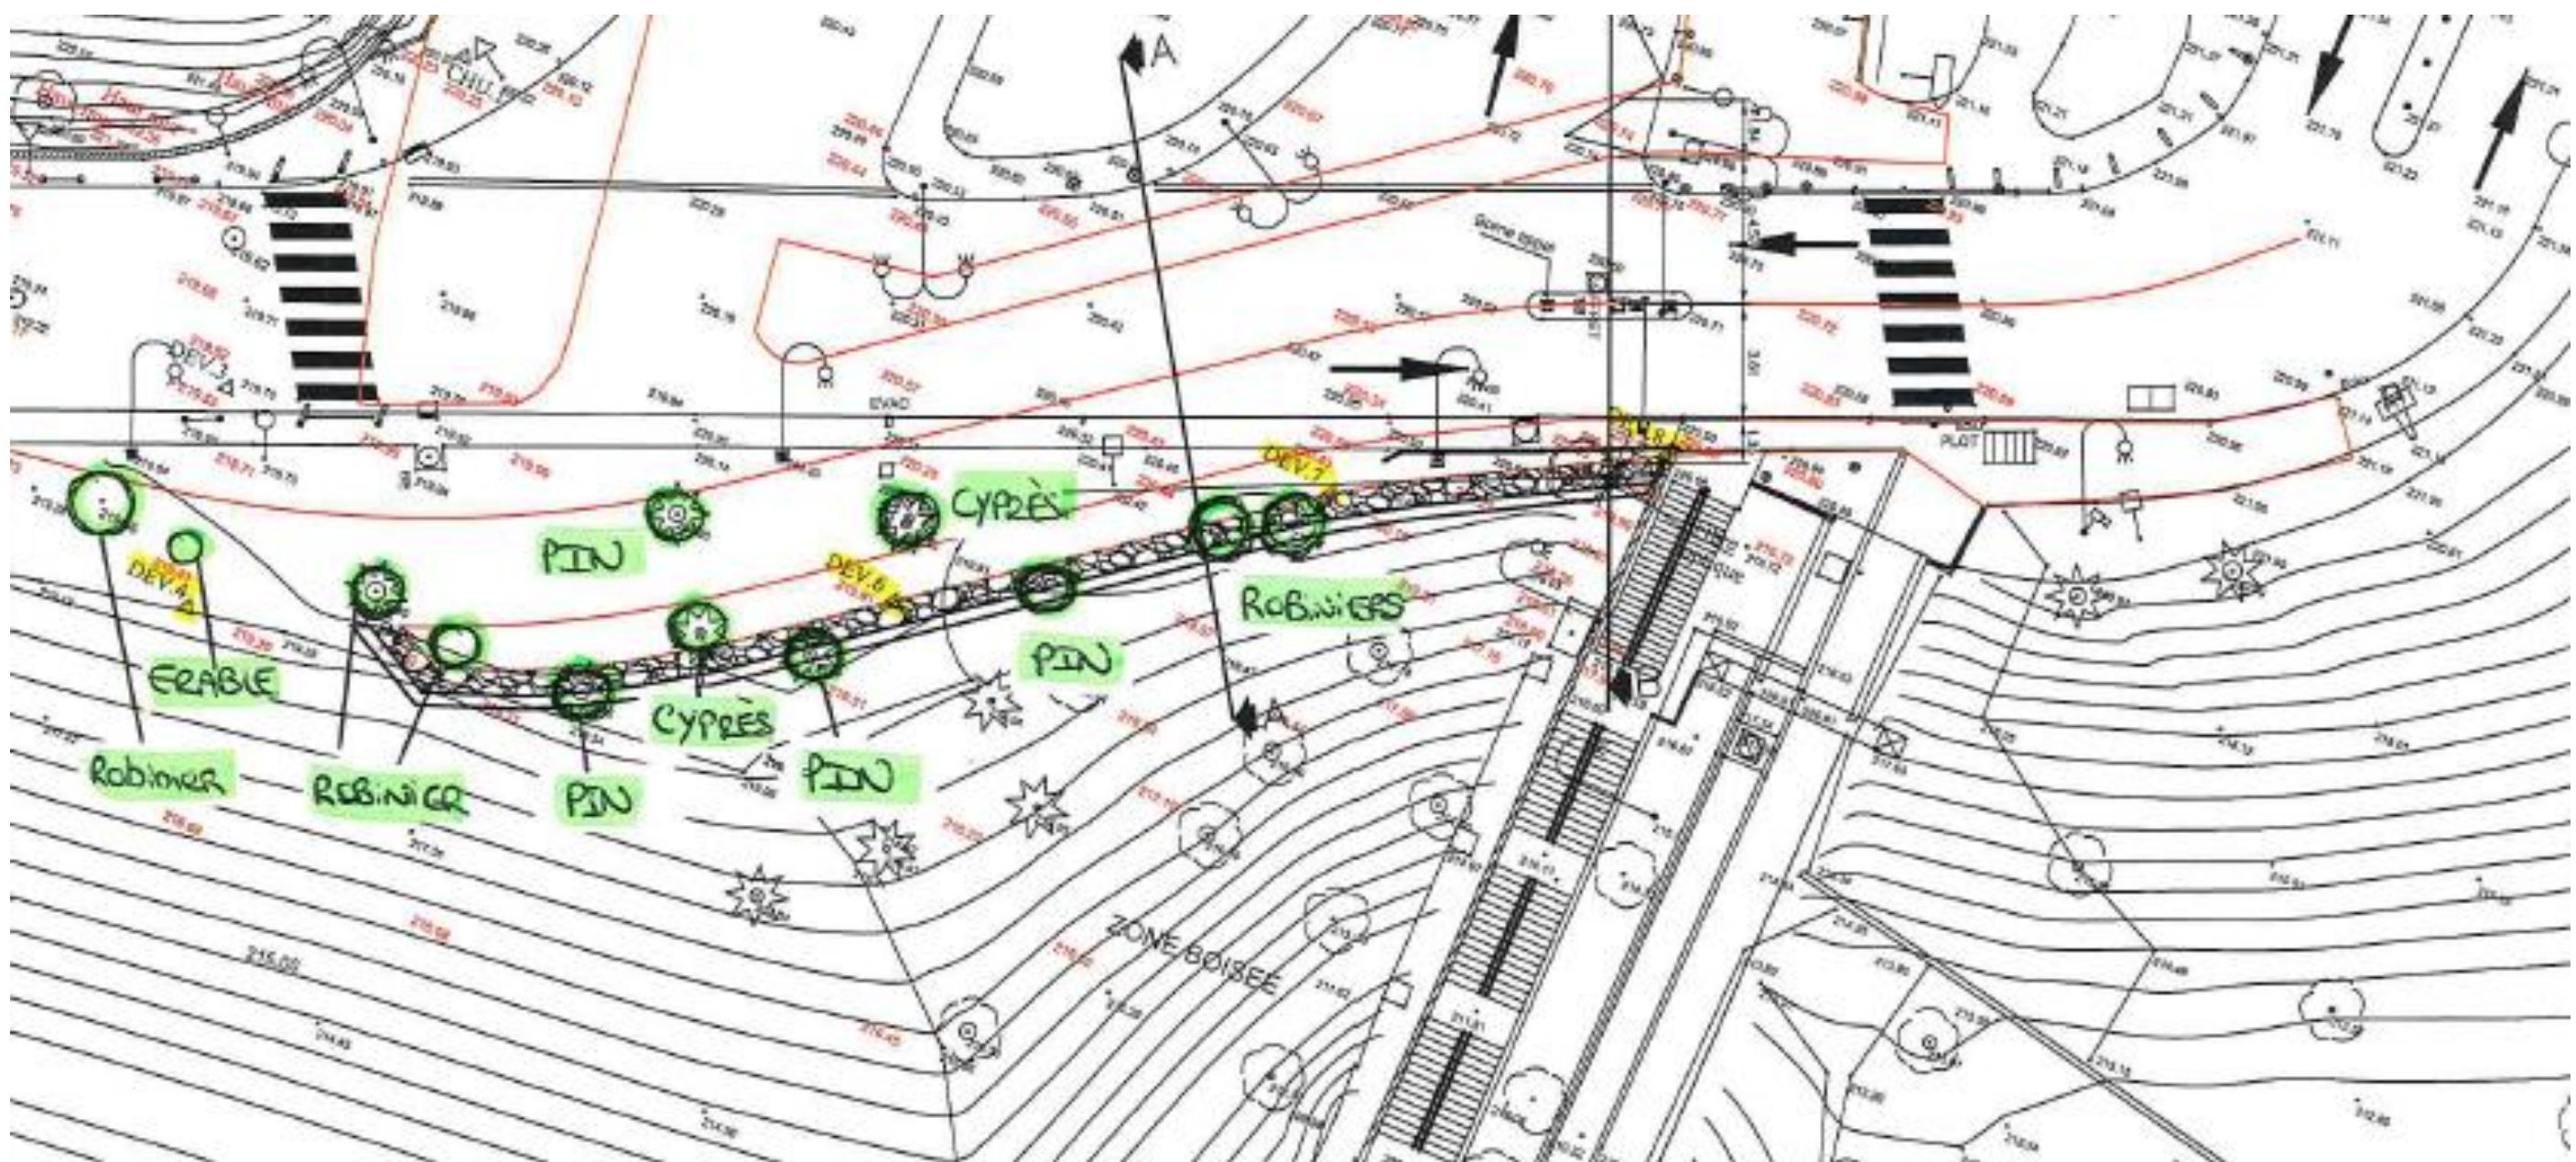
Plan EXE des 12 arbres à abattre pour les travaux de dévoiement de la route d'accès au CHU
